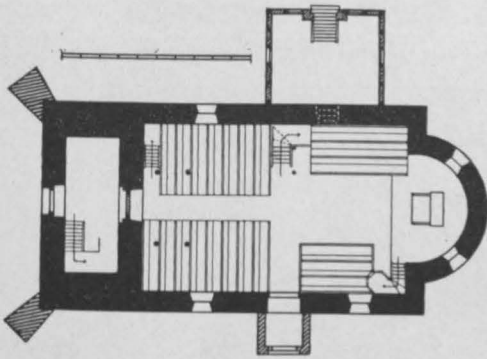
Sieversdorf. Grundriss der Kirche.
